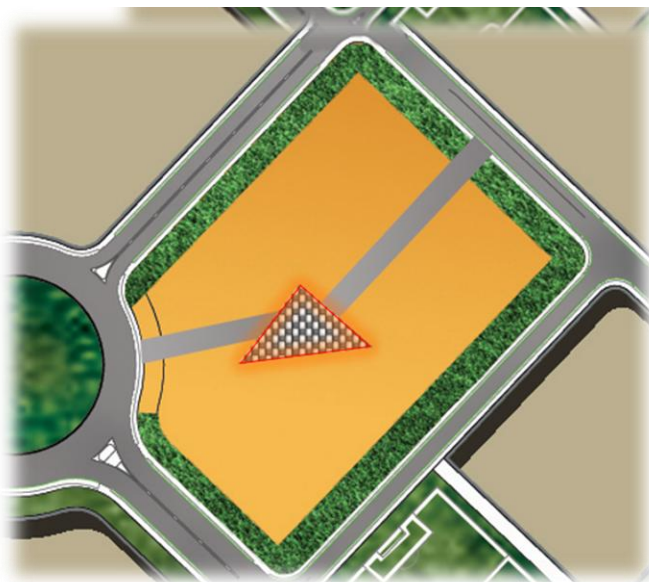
étape 4 de plan d'aménagement (source : auteur)
